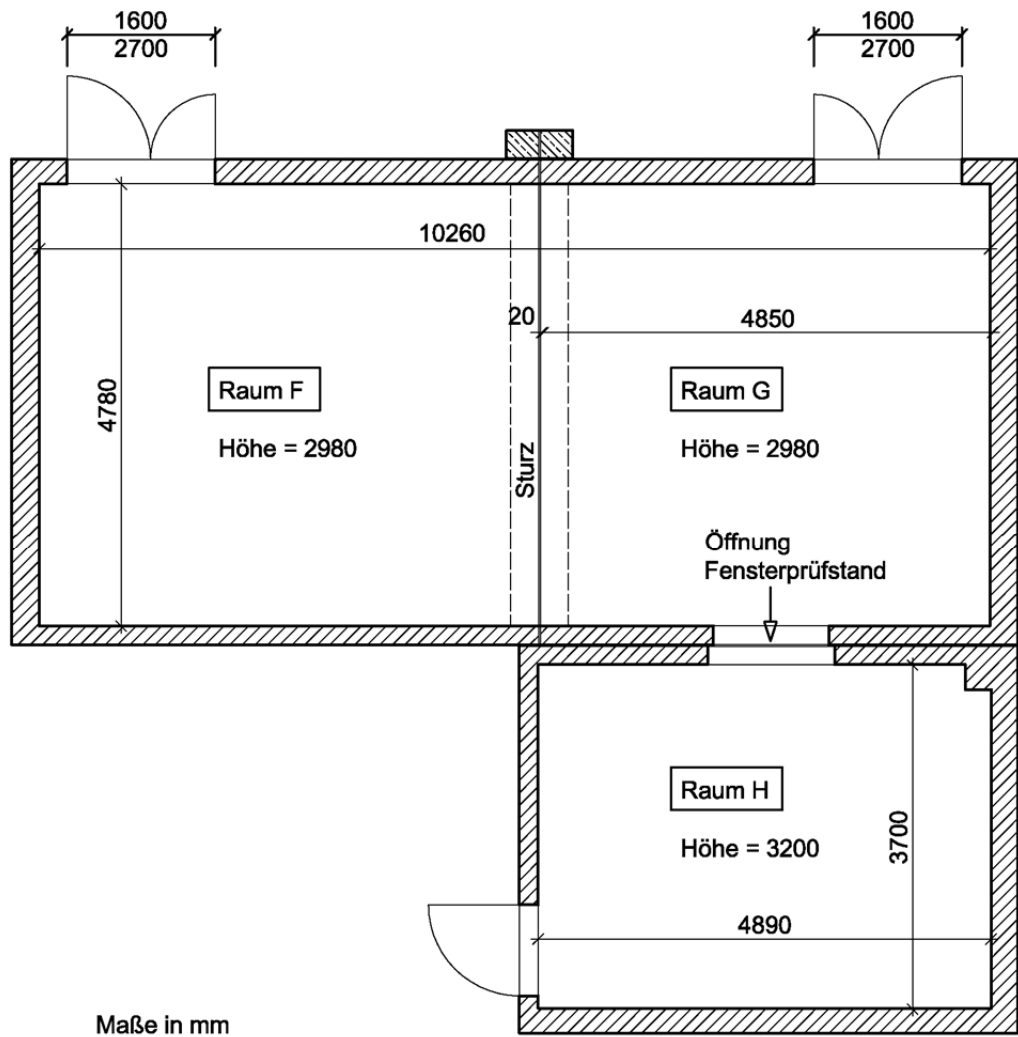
Grundriss des Fensterprüfstands.
